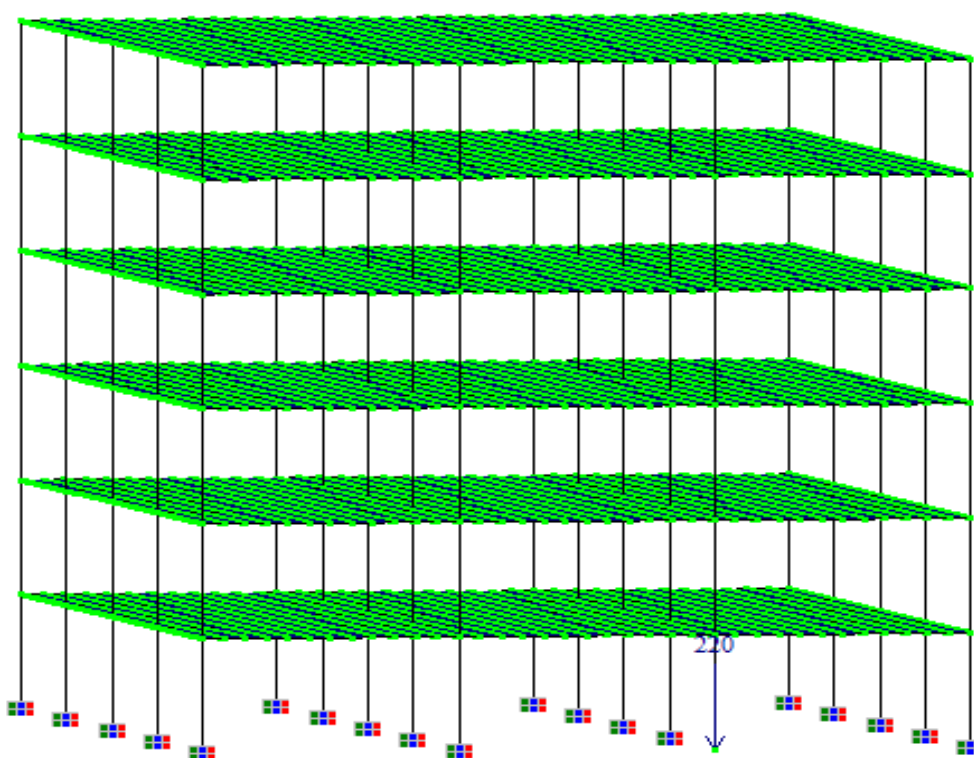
Schéma illustratif du modèle d'étude du bâtiment avec planchers en hourdis à 6 niveaux avec un chargement vertical sur le poteau de rive
